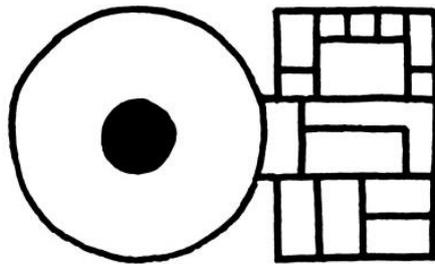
Planta esquemática de la separación de la observación y el resto de funciones.
